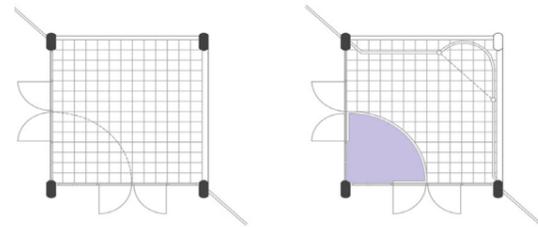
Terrazas cubiertas de las guarderías. En la terraza superior se señala el hueco existente. Elaboración propia.
